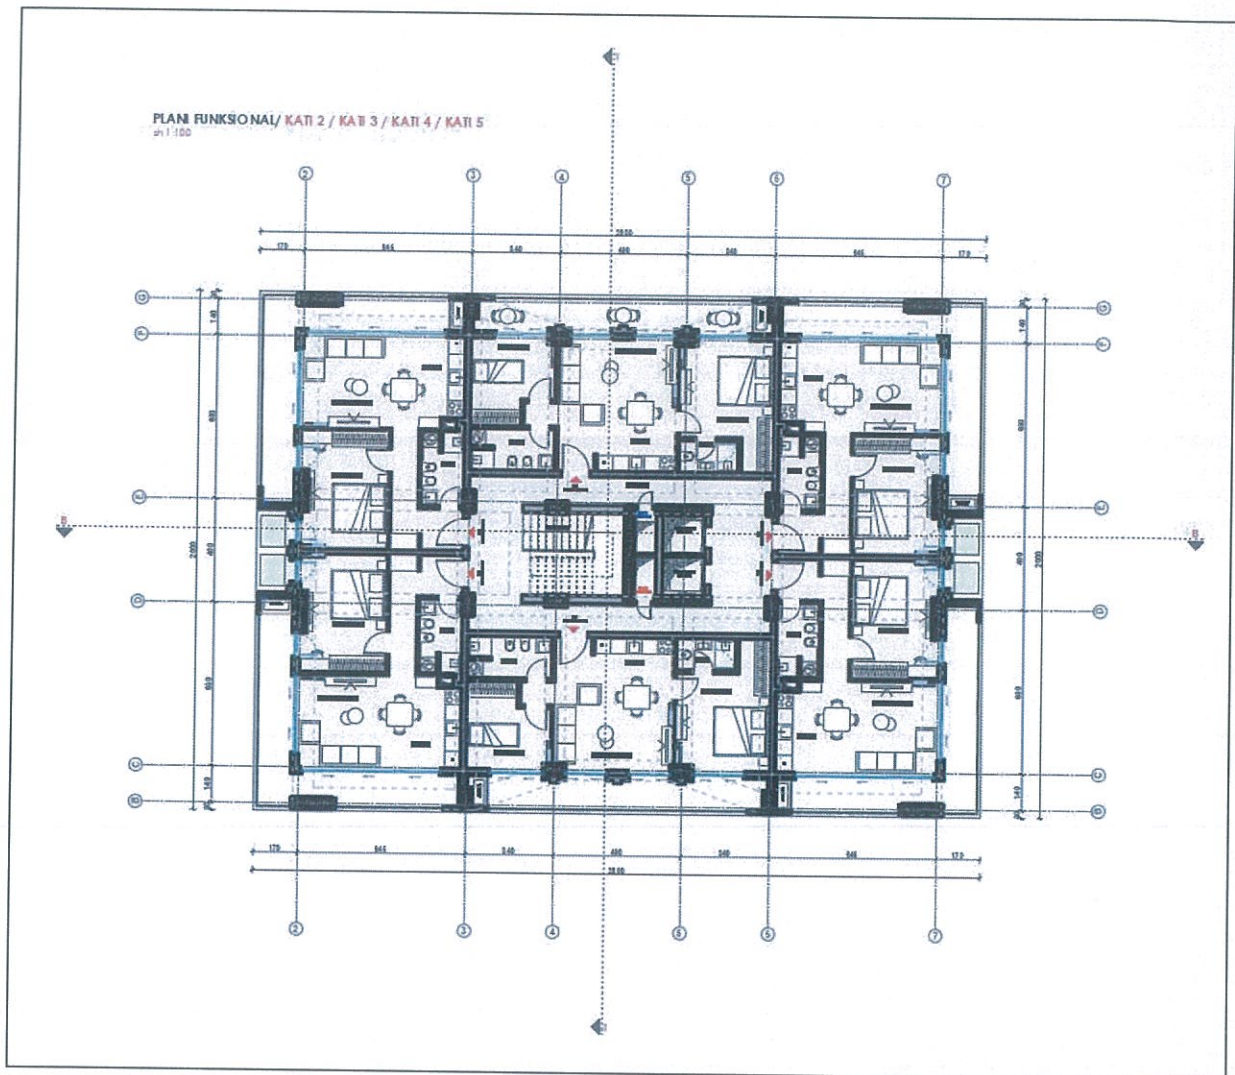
Planimetria e kateve +2; +3; +4; +5; katet tip të objektit
